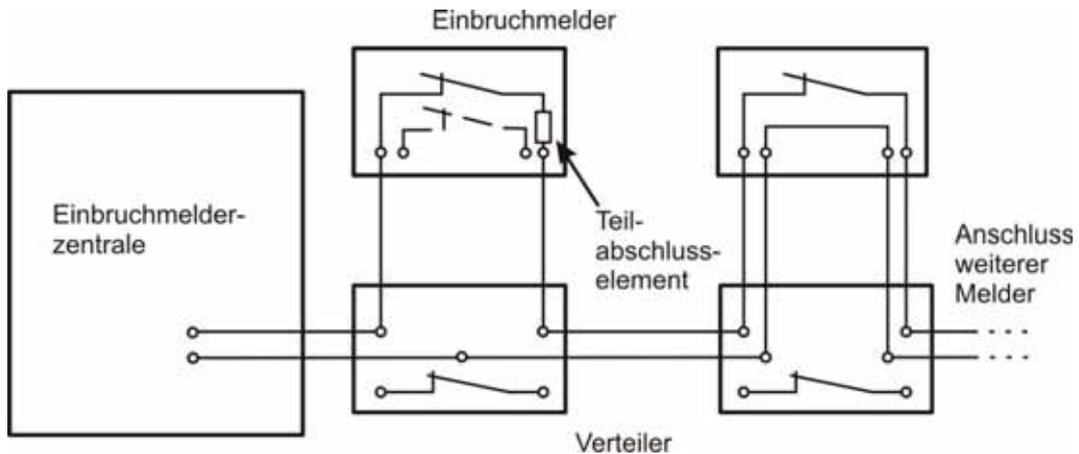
Anschluss von Meldern mit Teilabschlusselement
